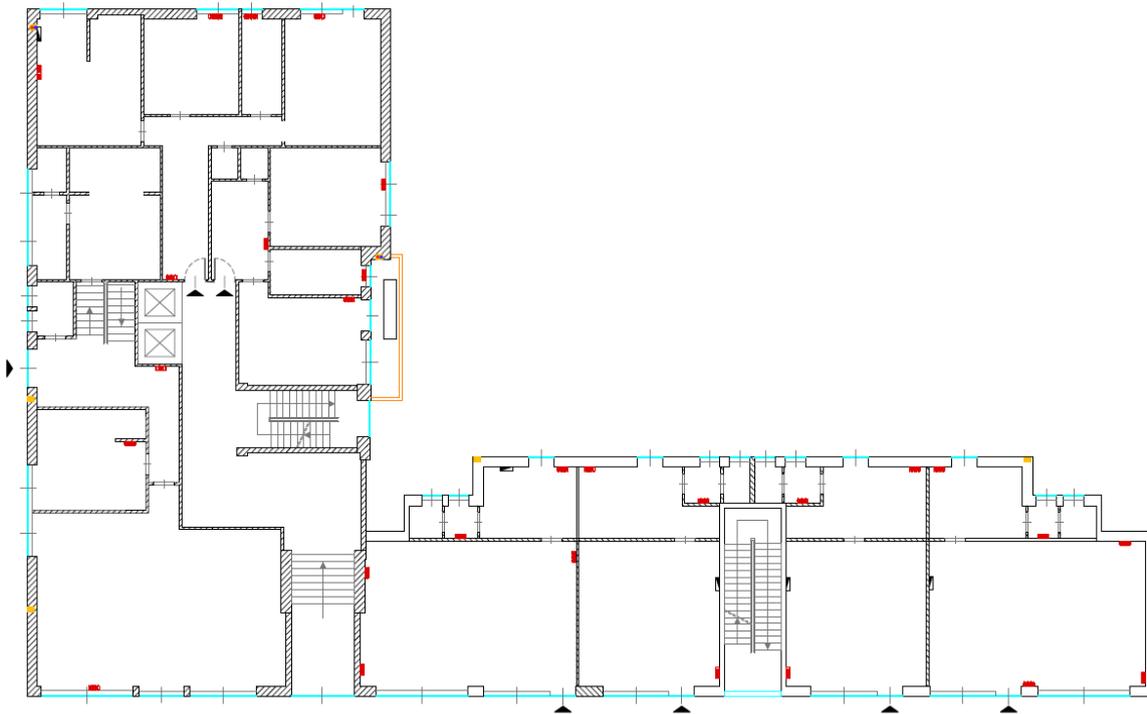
Pianta completa piano terra edifici n.35 e n.35-bis
